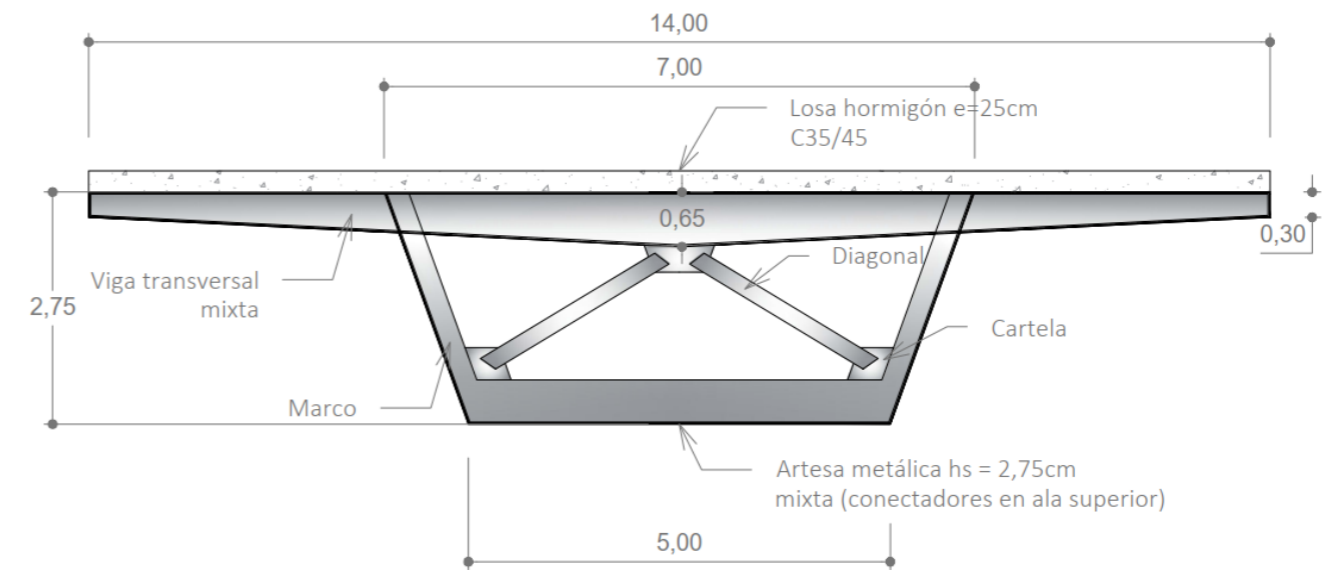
Sección transversal alternativa 1 puente viga (fuente: elaboración propia)
